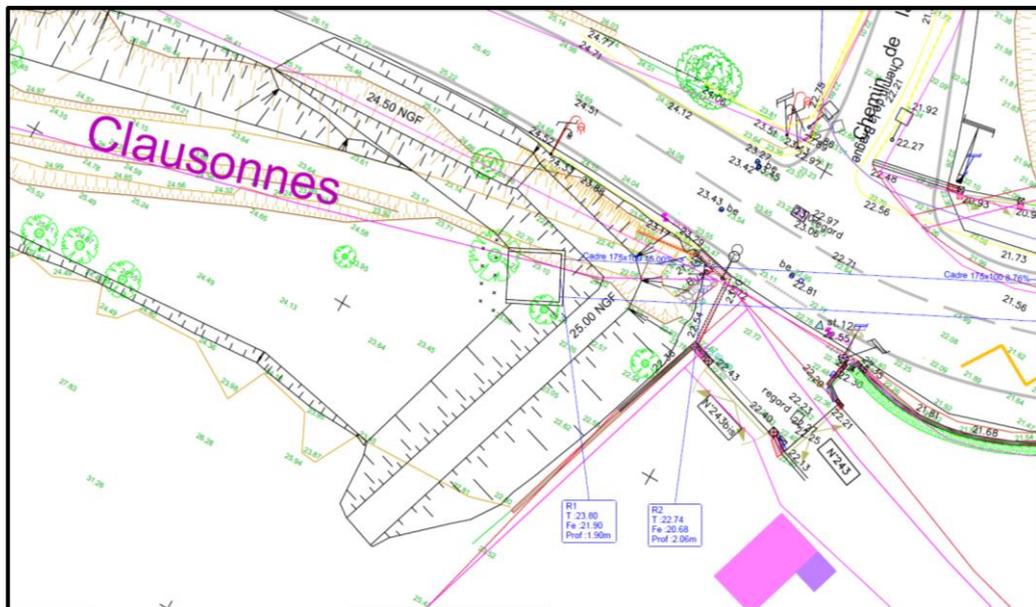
Extrait de la vue en plan de l'ouvrage à réaliser
